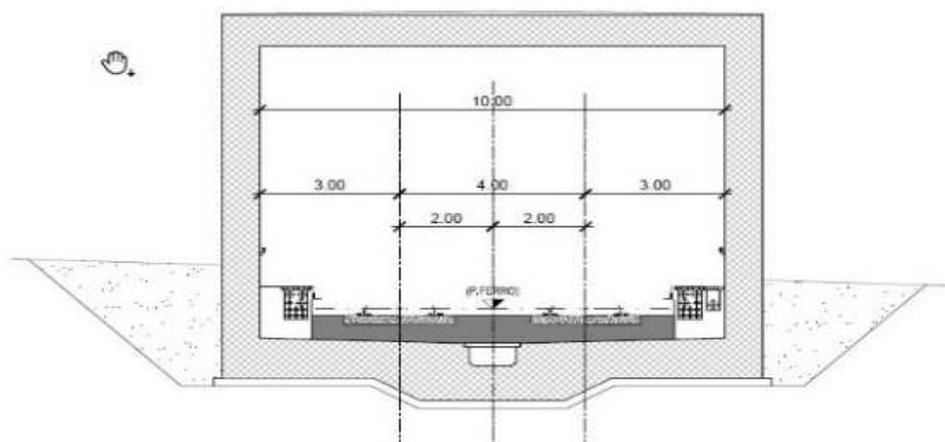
Sezione trasversale in galleria, tipo A(da elaborato1.f)
